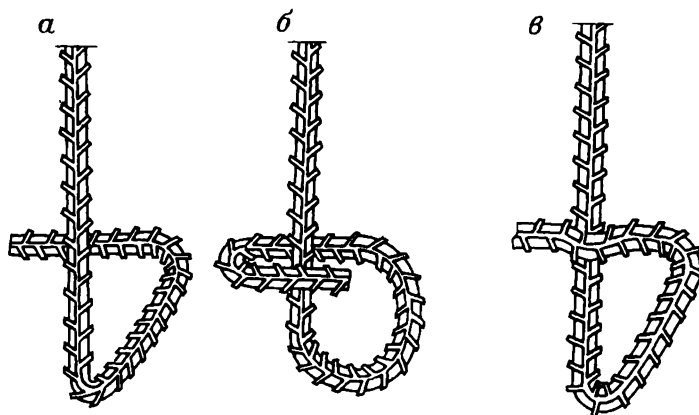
Конструкции податливых опор железобетонных анкеров
